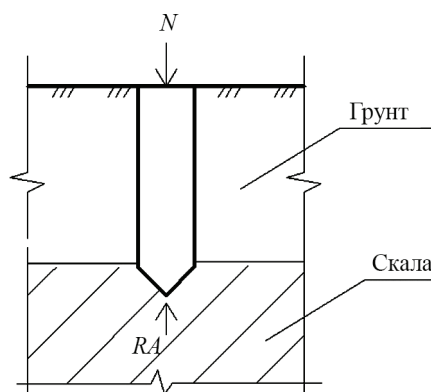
Расчетная схема сваи-стойки в грунте основания
